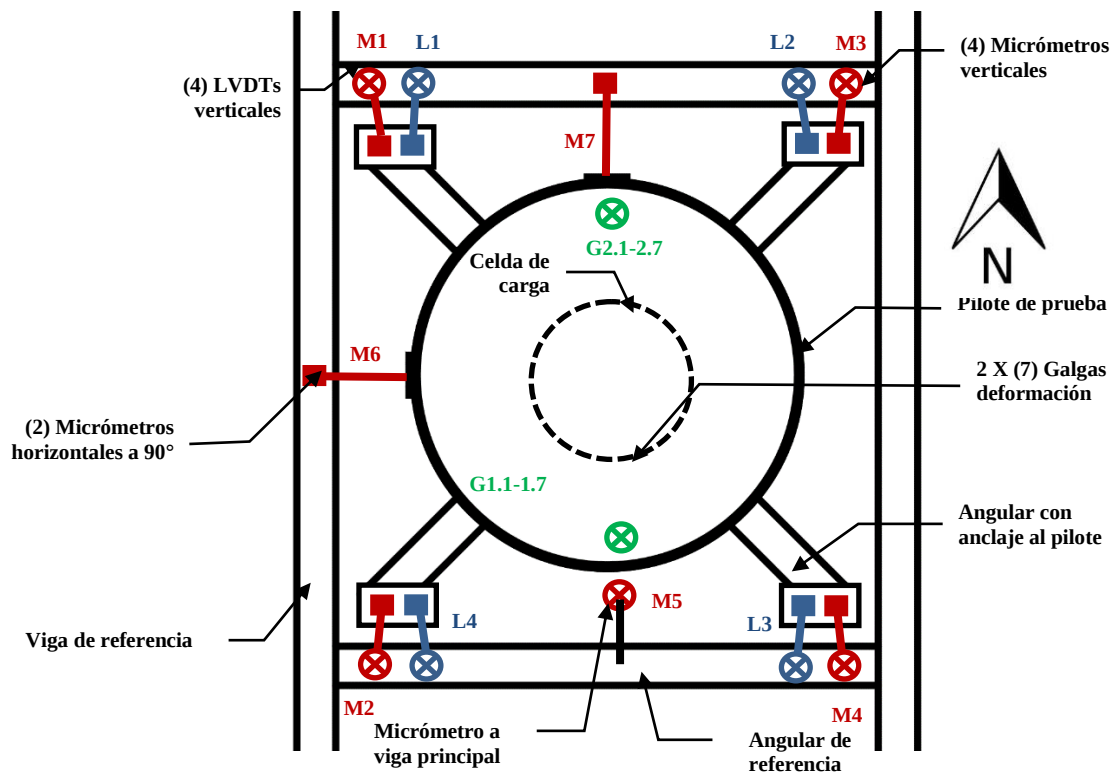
Planta de pilote de prueba con instrumentos (Celda de carga, LVDTs, galgas y micrómetros)
